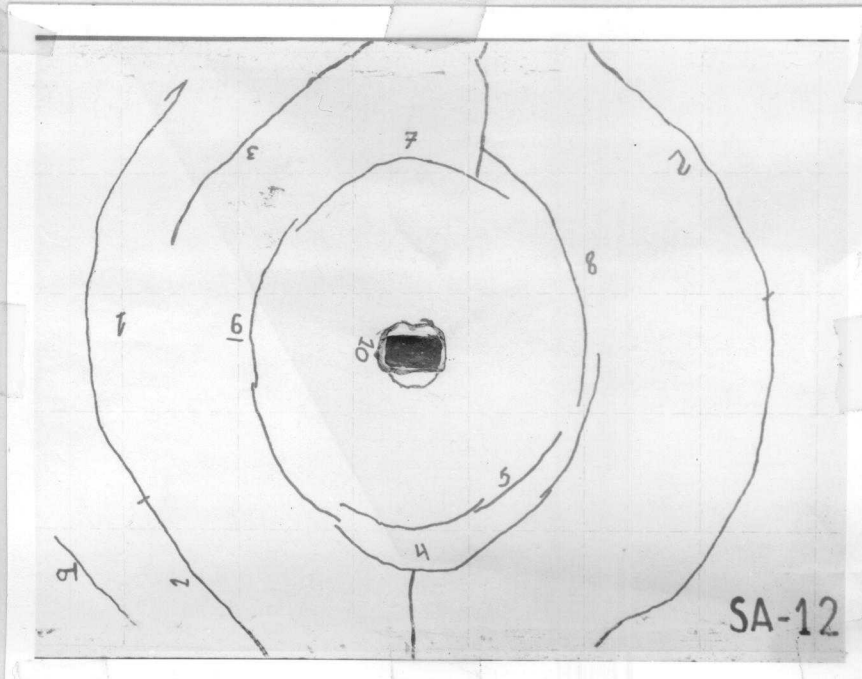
Configuração de ruína (face superior) da Laje SA-12.
